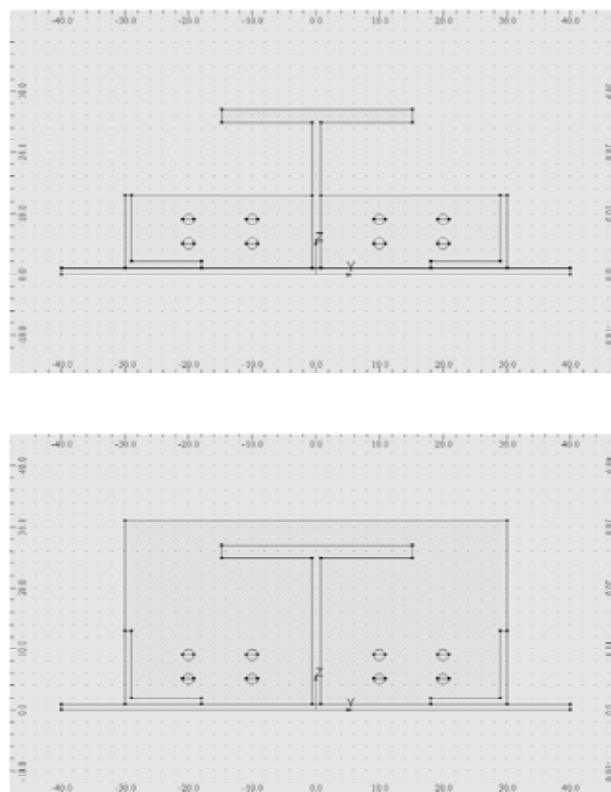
Secciones jácena mixta. Fase construcción - Fase servicio.
